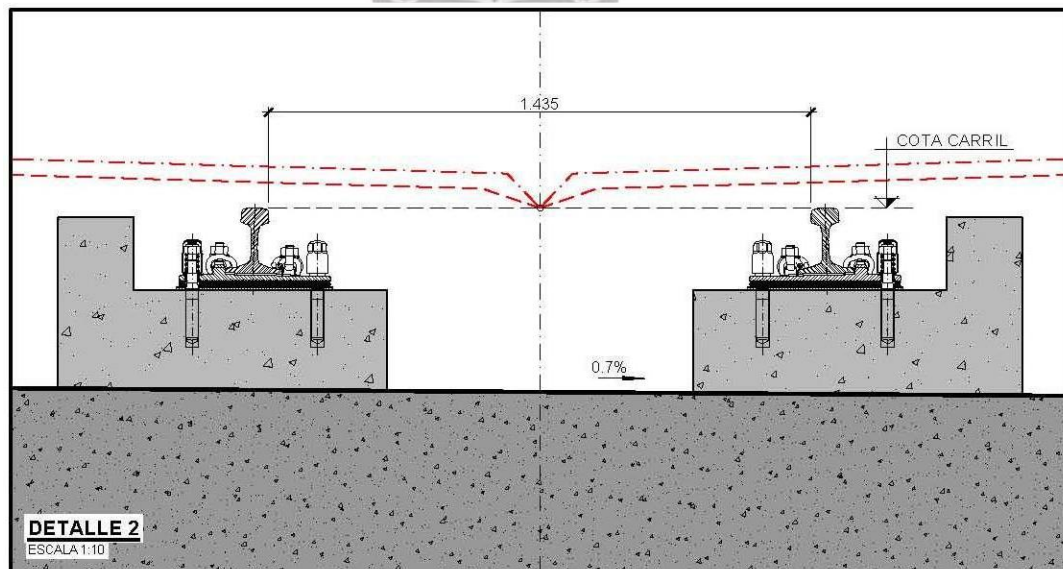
Tendido de vía en placa, fijación directa sobre el plinto
